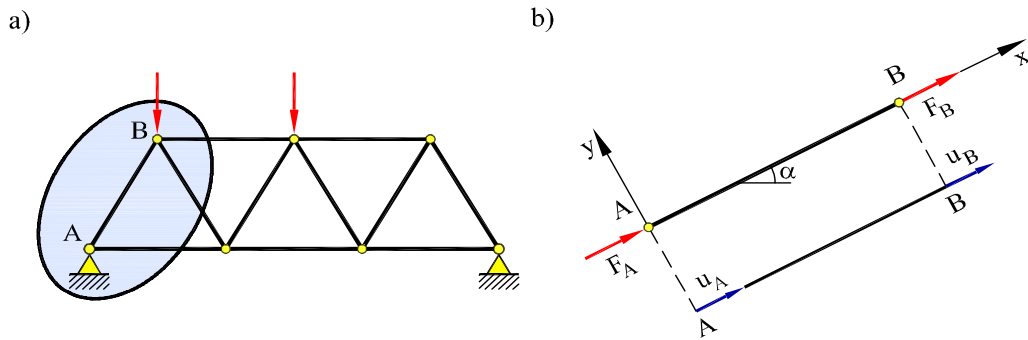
(a) Estructura articulada (b) barra aislada
